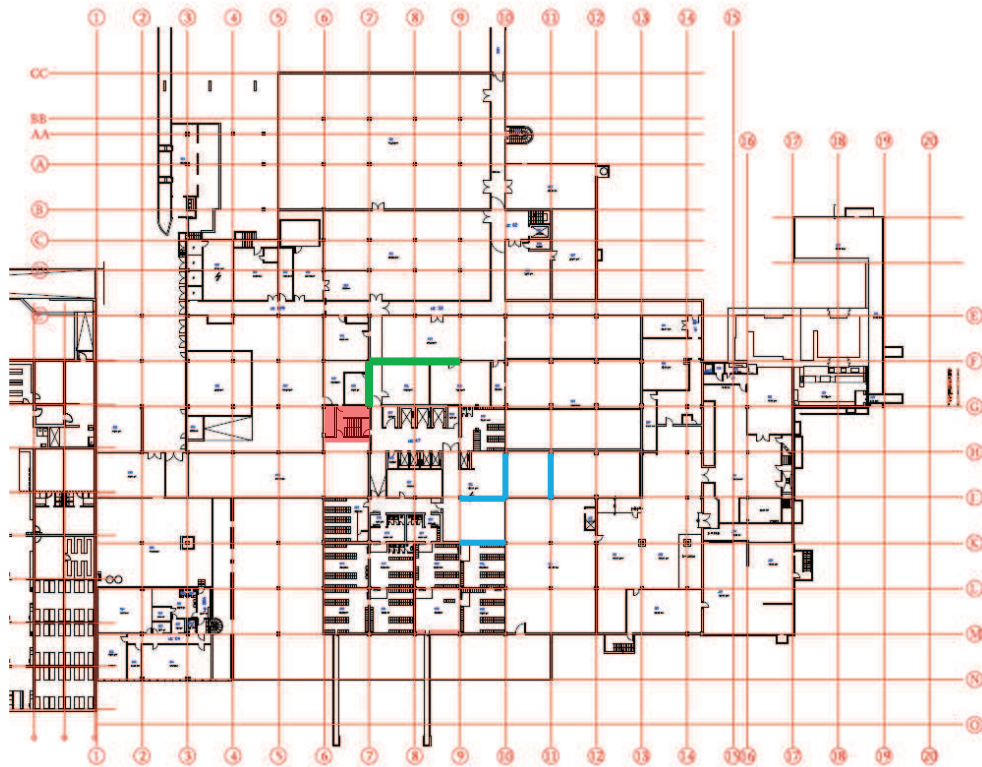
Plan du sous-sol, niveau U. Nouveaux murs en béton armé.
